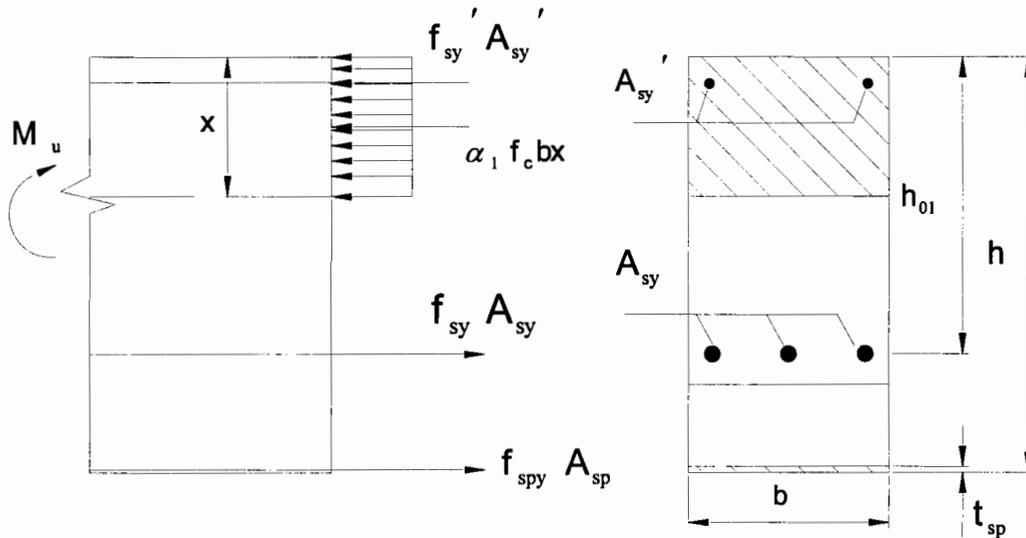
钢板-混凝土组合加固矩形梁正截面抗弯承载力计算图示
